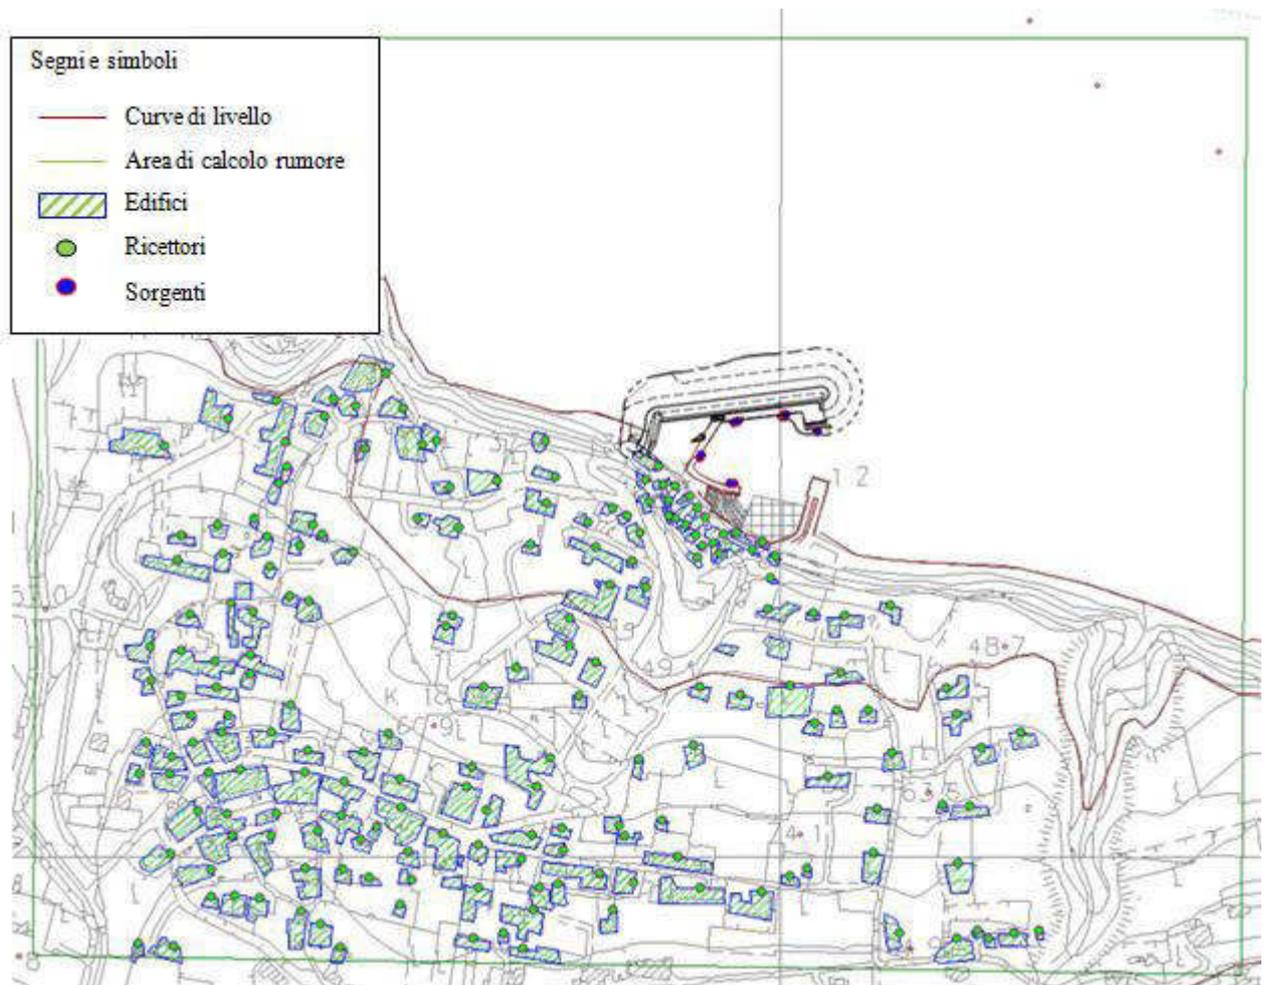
Planimetria fase futura – Configurazione 1: posizionamento delle sorgenti di rumore
